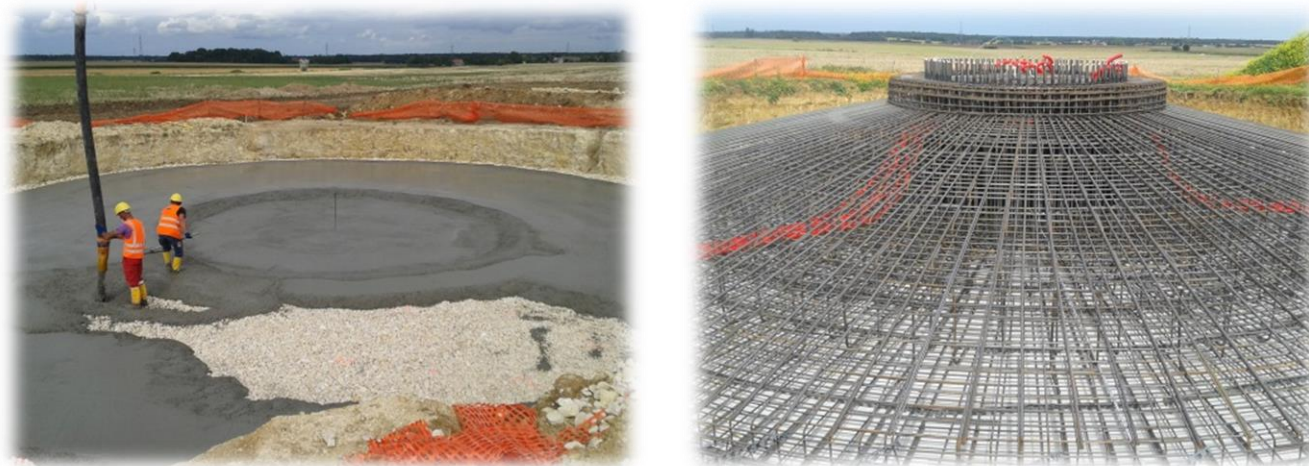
coulage du béton de propreté (à gauche) et ferrailage du massif de fondation (à droite)
